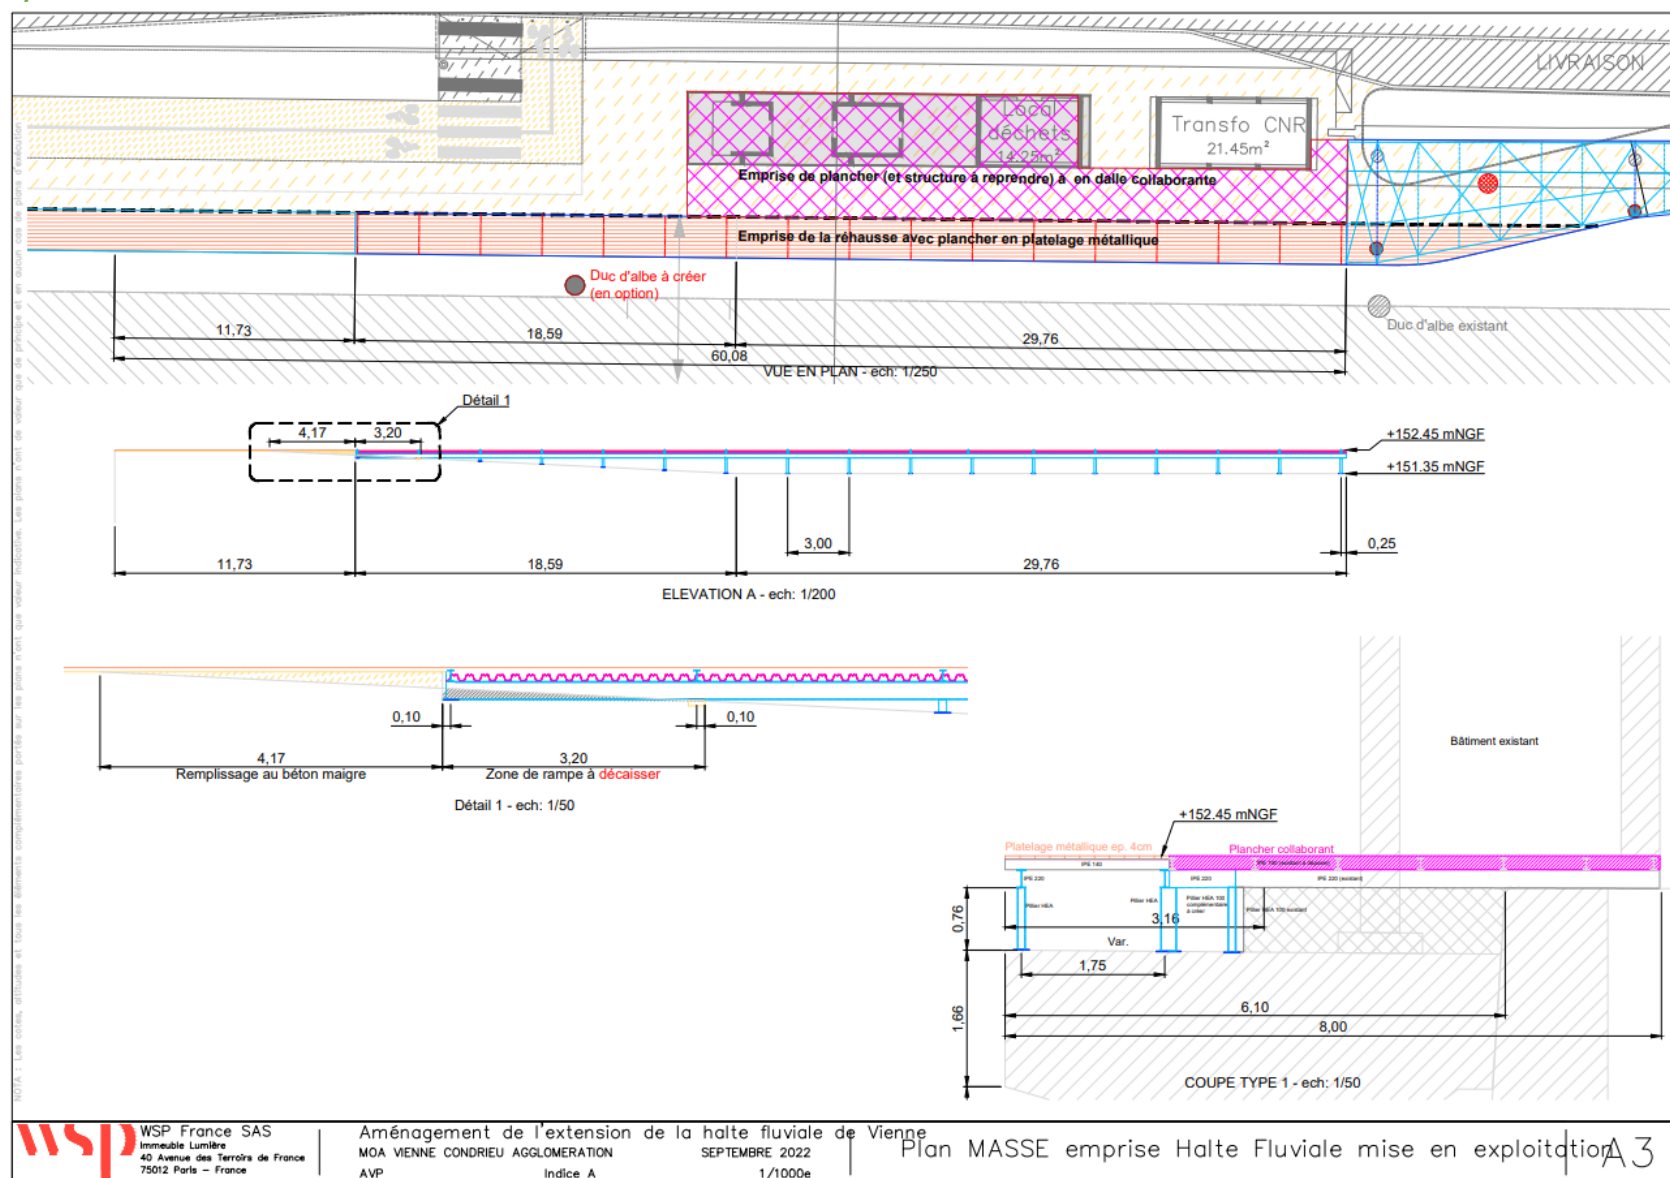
Plan masse et coupes emprise halte fluviale (2)
